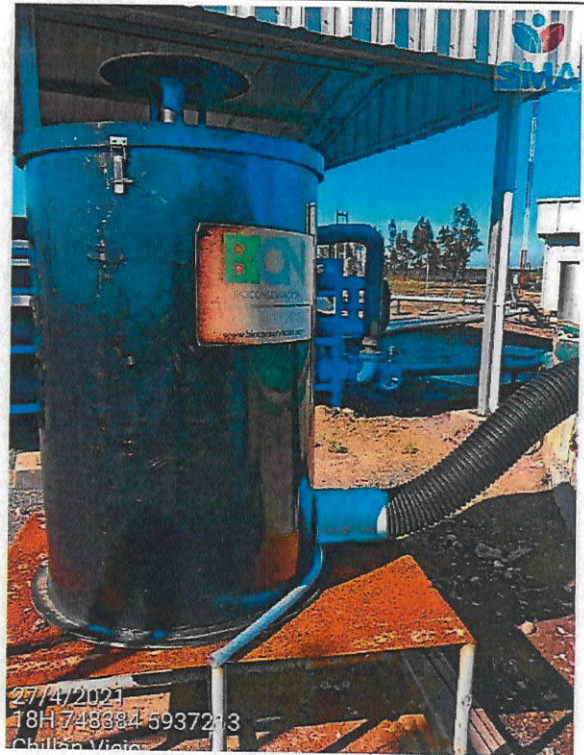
Estación N° 5 biofiltro pozo de distribución.
